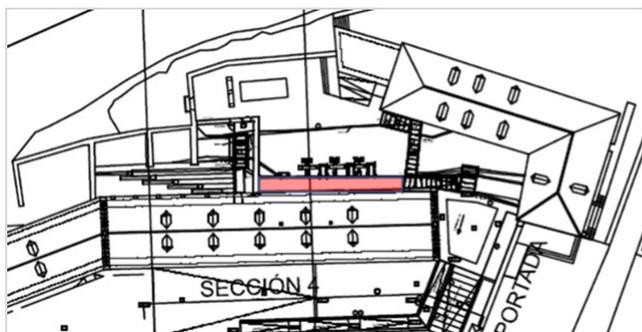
Planta de ubicación del canal a impermeabilizar y detalle del canal.
